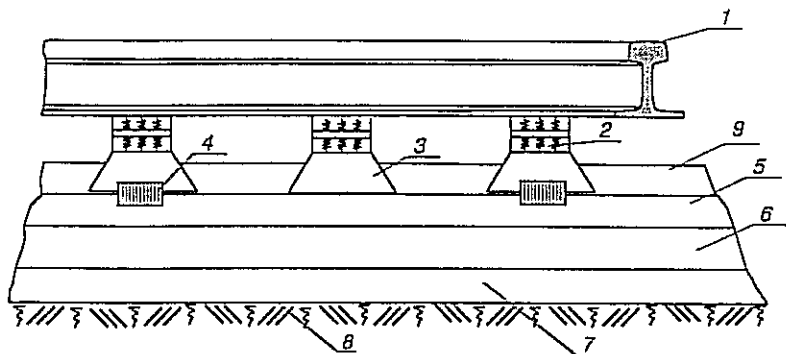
а - 1-рельс; 2-упругие подкладки; 3-подрельсовая конструкция-блочная; 4-фундаментные плиты; 5-усиленное основание; 6-земляное корыто.
